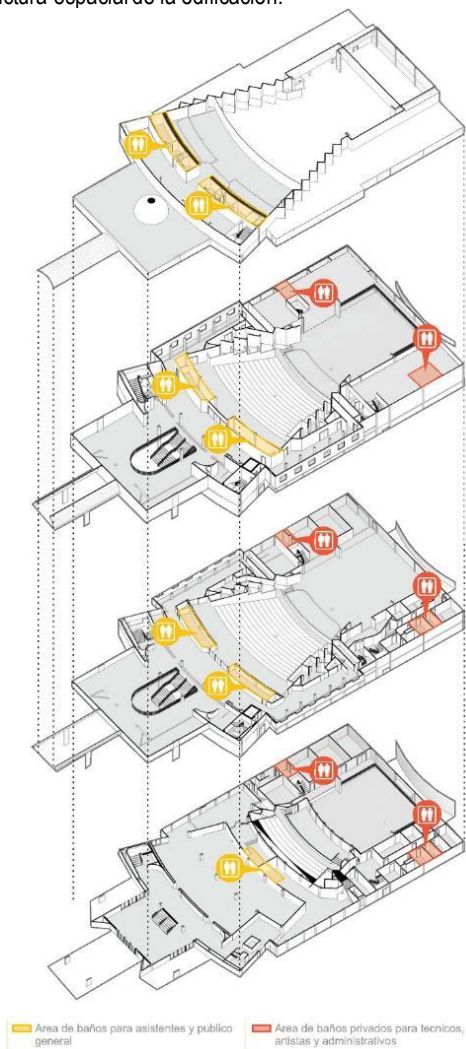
Esquema de ubicación de baños Planta Primer Piso
